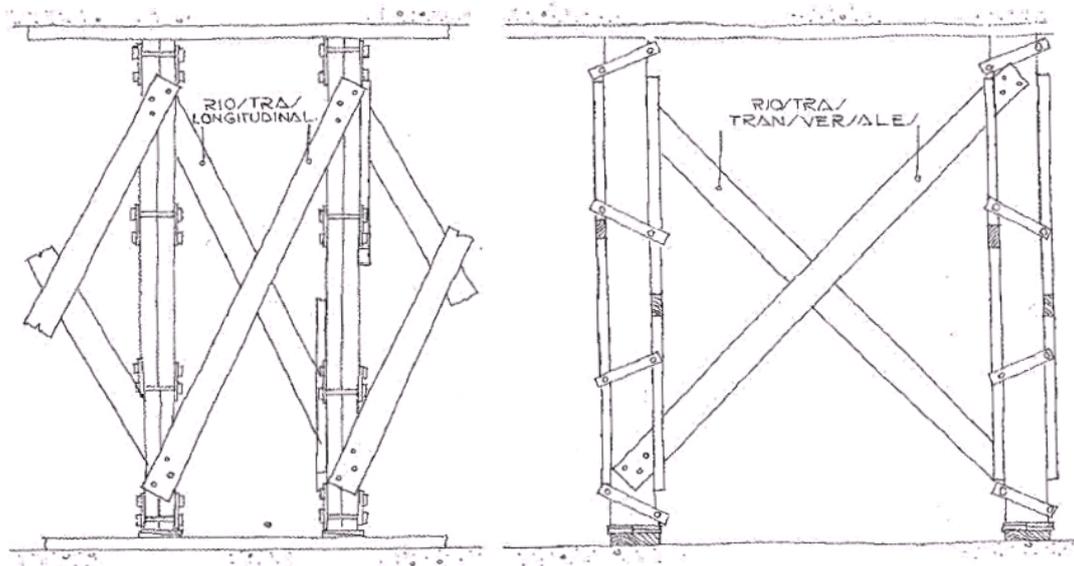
Arriostramiento de pies derechos en forma de aspa.
